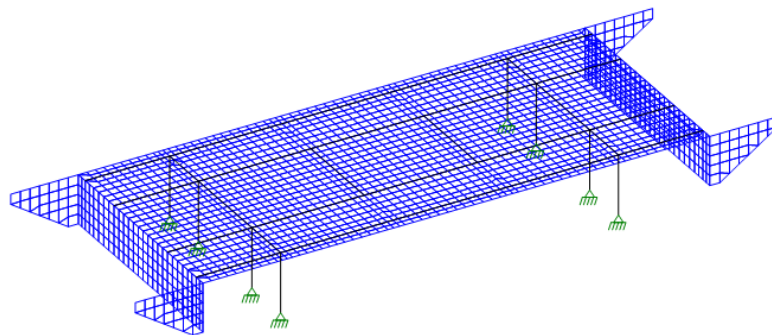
Discretização do tabuleiro alargado, com introdução de novas vigas e pilares.
